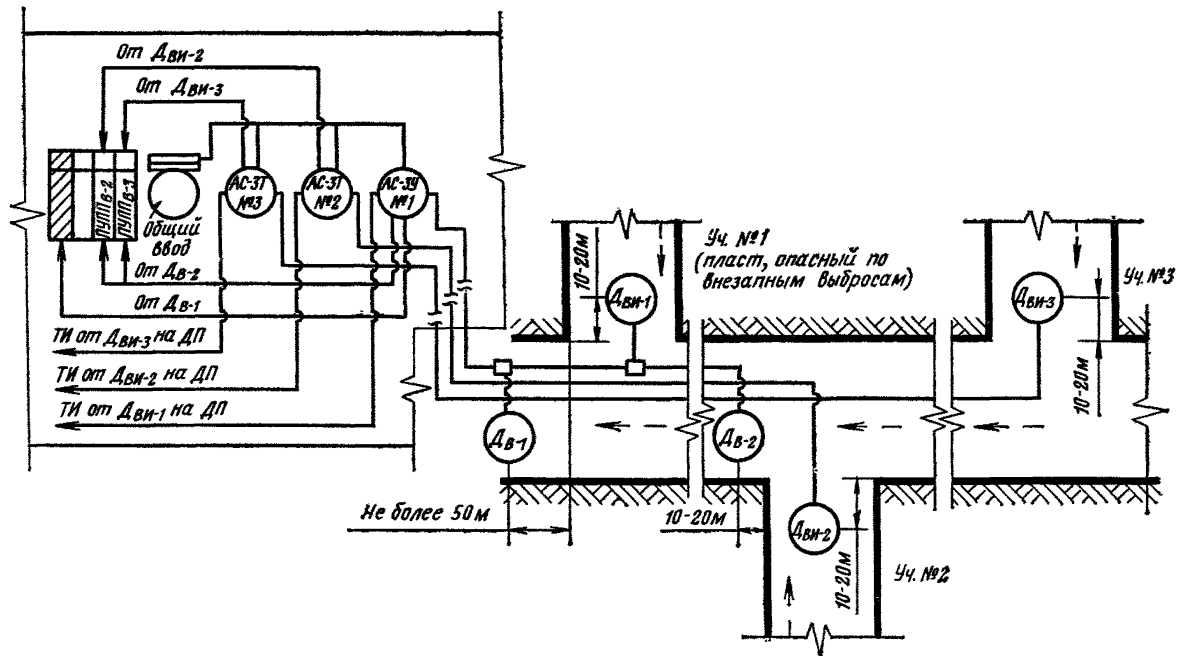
Схема размещения аппаратуры АГЗ в выработках вентиляционного горизонта в шахтах, опасных по внезапным выбросам, разрабатывающих крутые пласты
